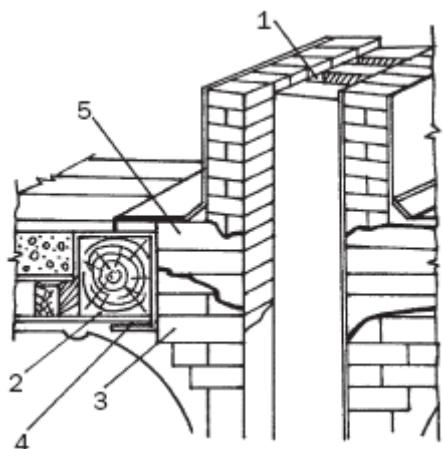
Разделка в месте выхода дымохода в междуэтажной деревянном перекрытии: 1 – дымовой канал; 2 – балка перекрытия; 3 – разделка в 1,5 кирпича; 4 – 2 слоя асбеста; 5 – разделка в 1 кирпич с дополнительной изоляцией
